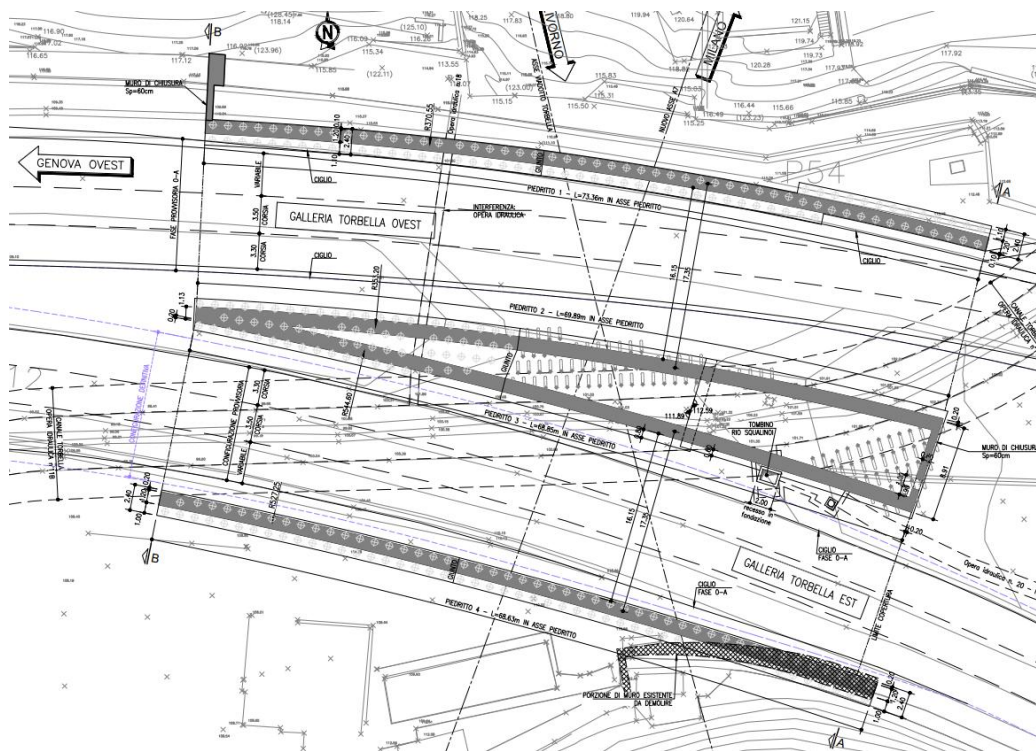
Pianta elevazioni galleria artificiale Torbella
